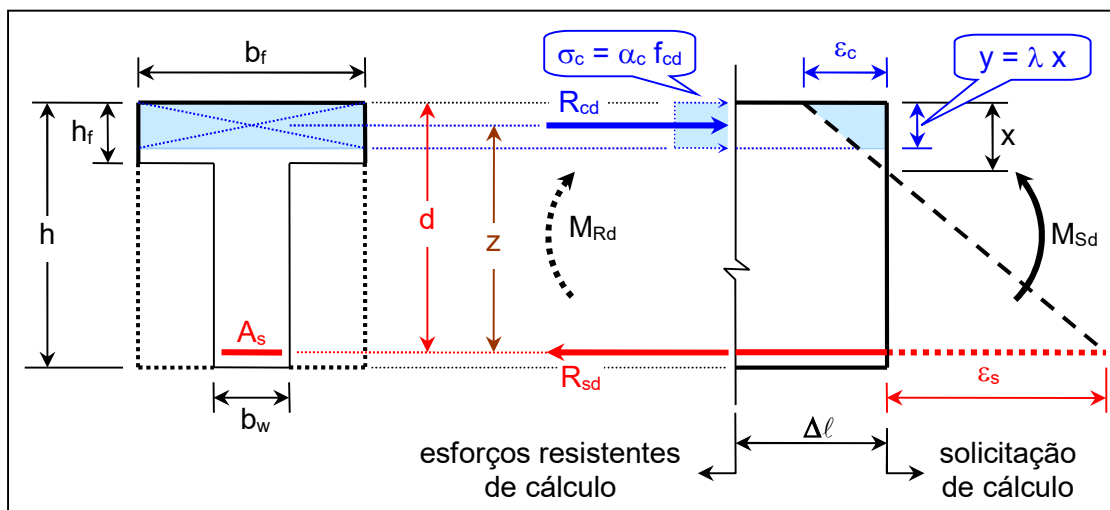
Vigas de seção T sem armadura de compressão - $y \leq h_f$
